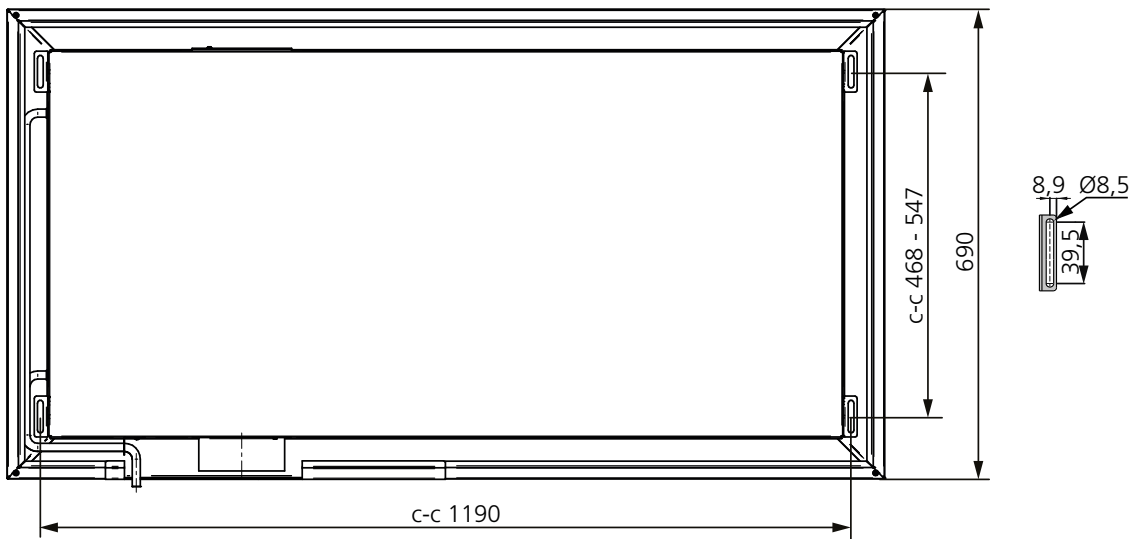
PARASOL EX 1290, Draufsicht (Beispiel mit Anschluss an Seite 2).
